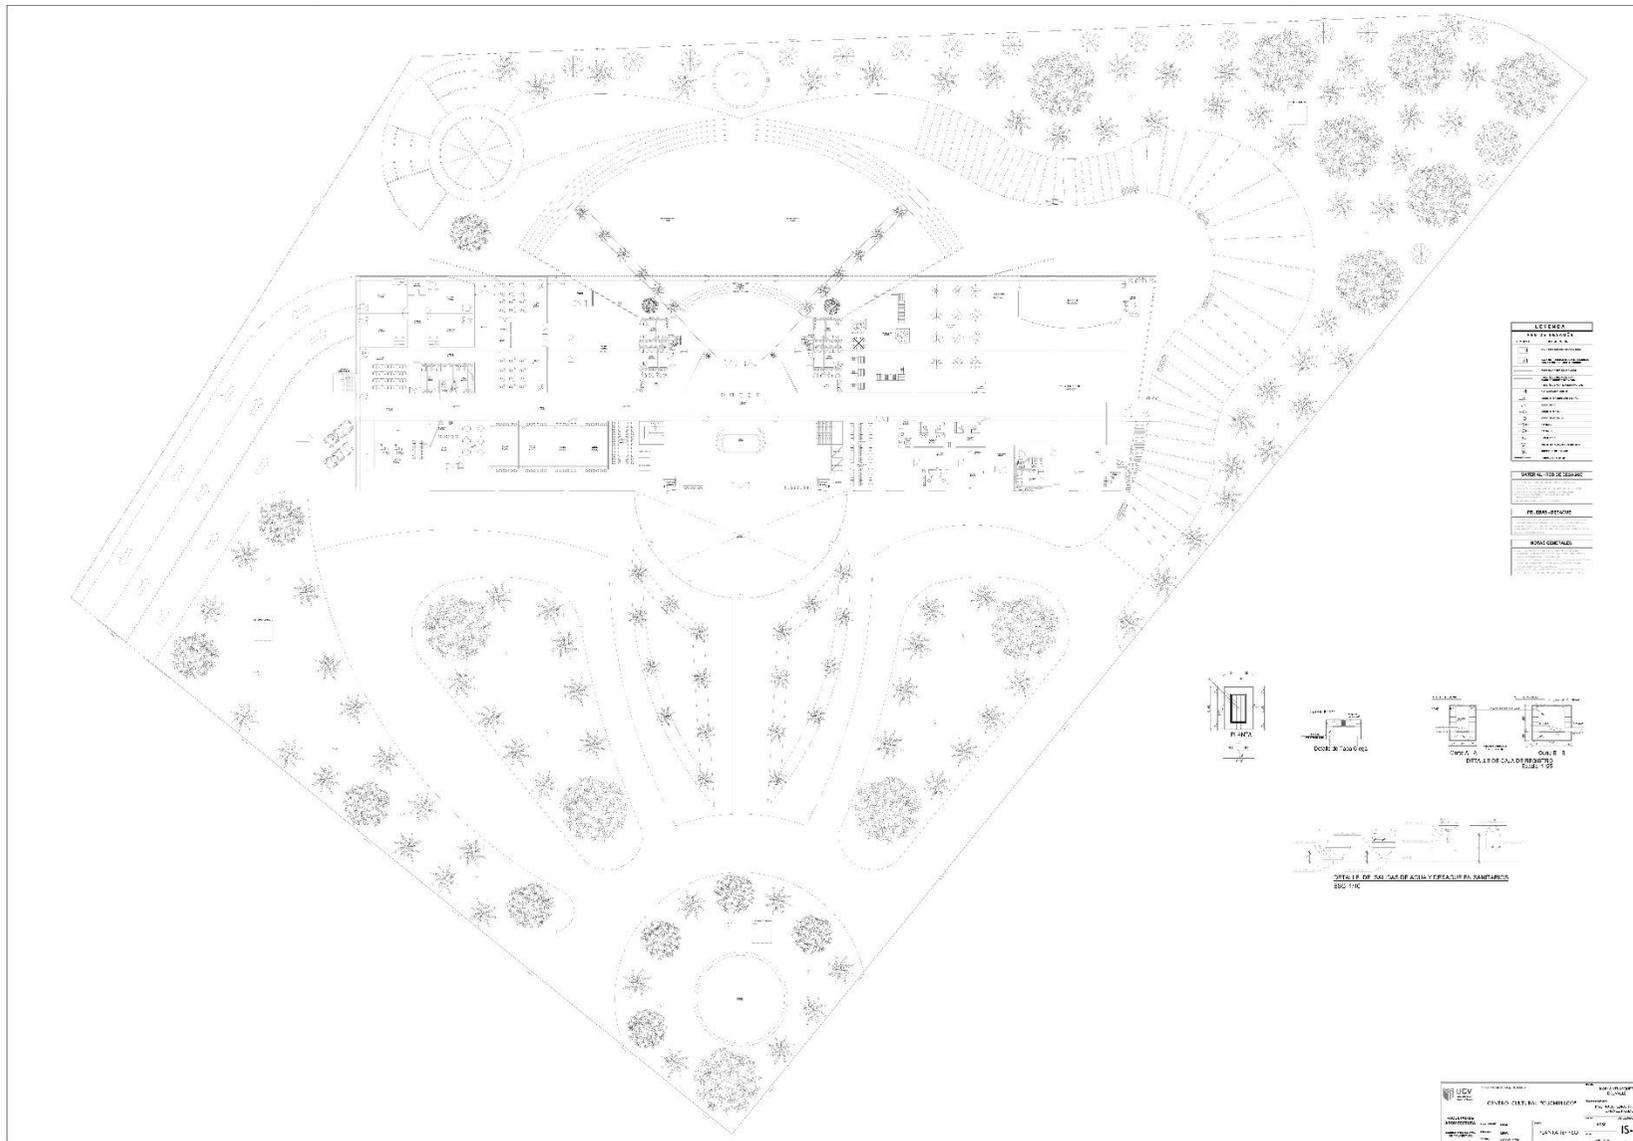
Plano de Desagüe Planta 1er Piso. Elaboración propia
